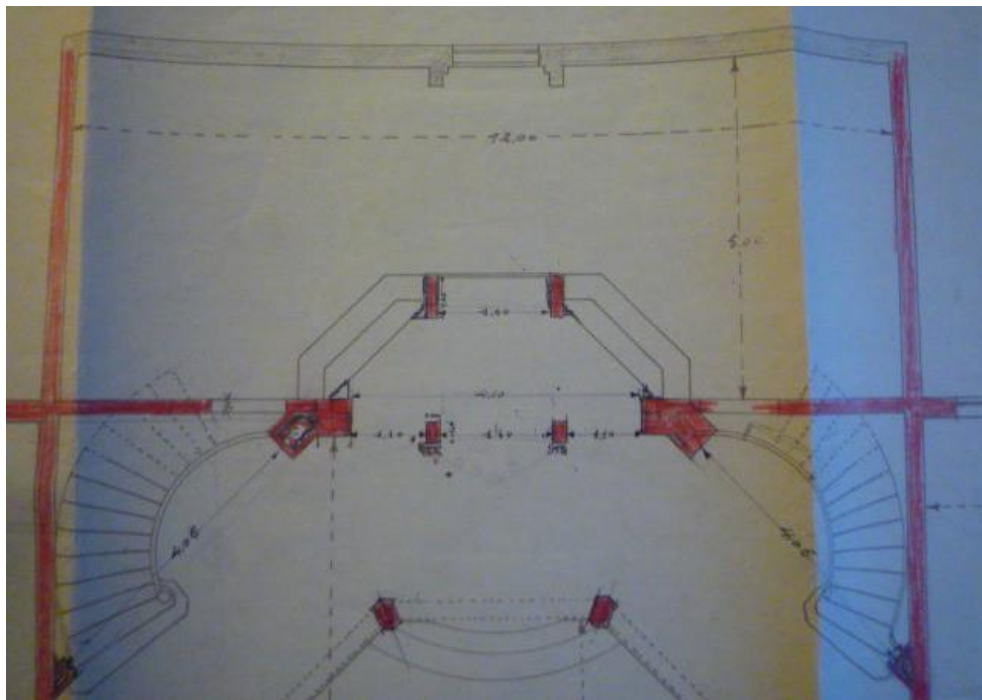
Detall del plànol original de la planta del Pavelló dels Artistes Reunits amb replanteig d'obra i cotes, 1929. [AFAD: Caixa Exposició Internacional de Barcelona, carpeta 33].
